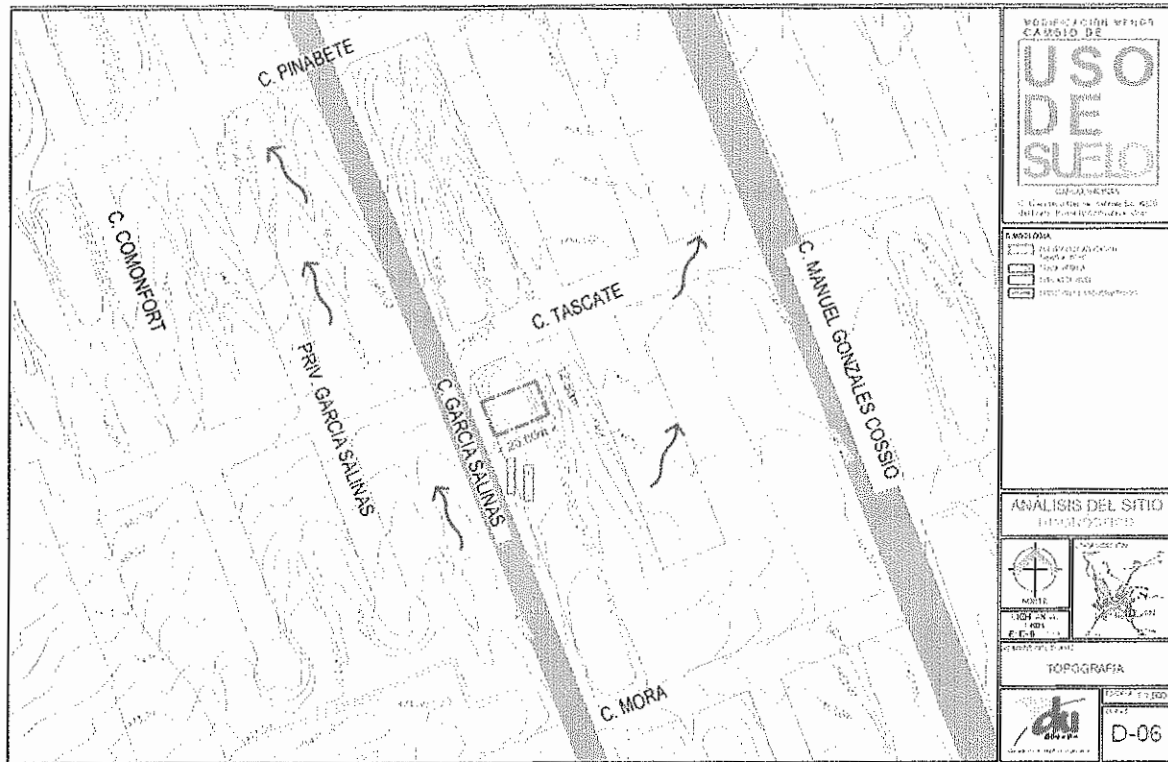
Plano topográfico. Fuente: Elaboración propia.
